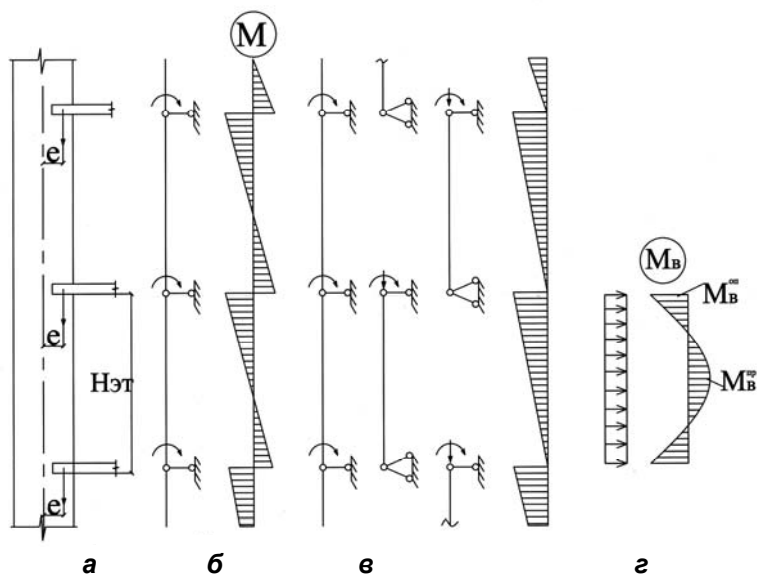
Расчетные схемы стены и эпюры изгибающих моментов
